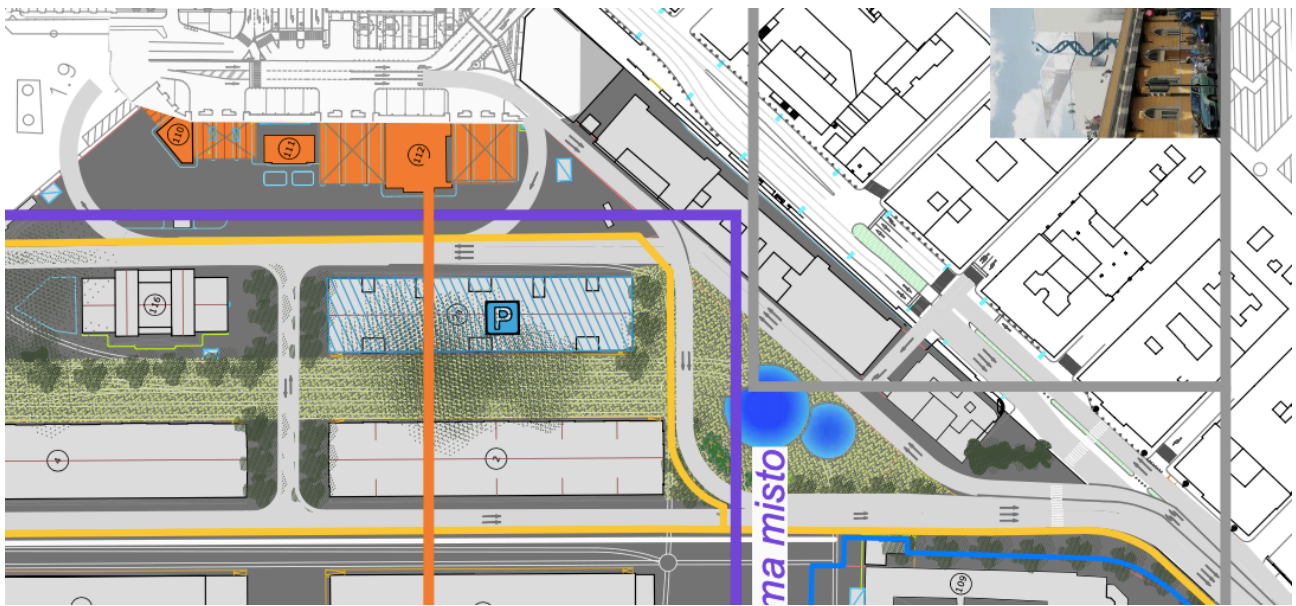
Assetto di progetto dell'Accesso Sud (fonte Masterplan Porto Vecchio - Comune di Trieste)
